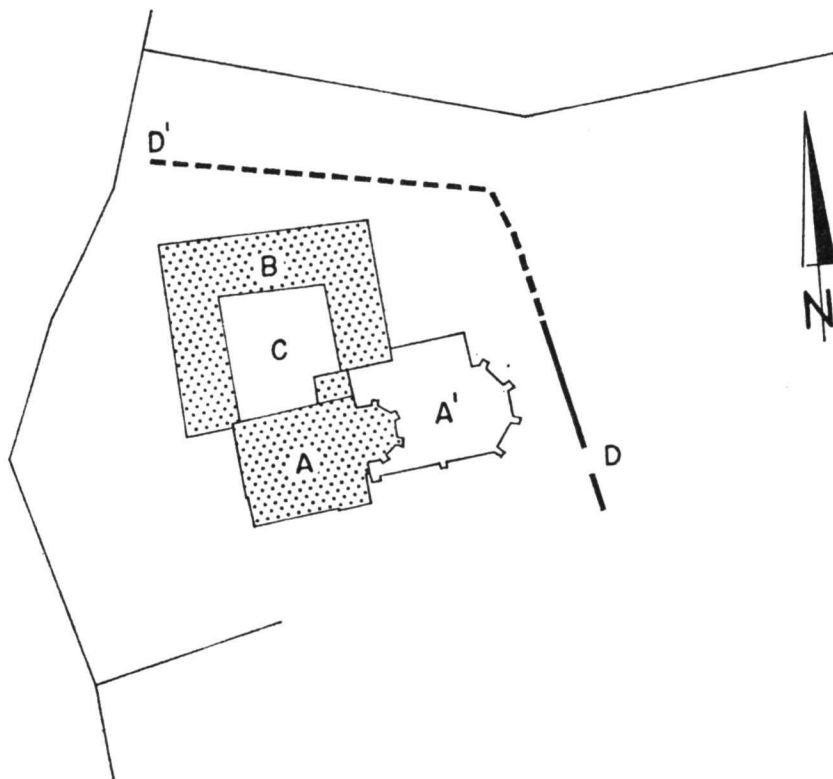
Plan de situation (XV^e siècle). Echelle 1 : 1000.
